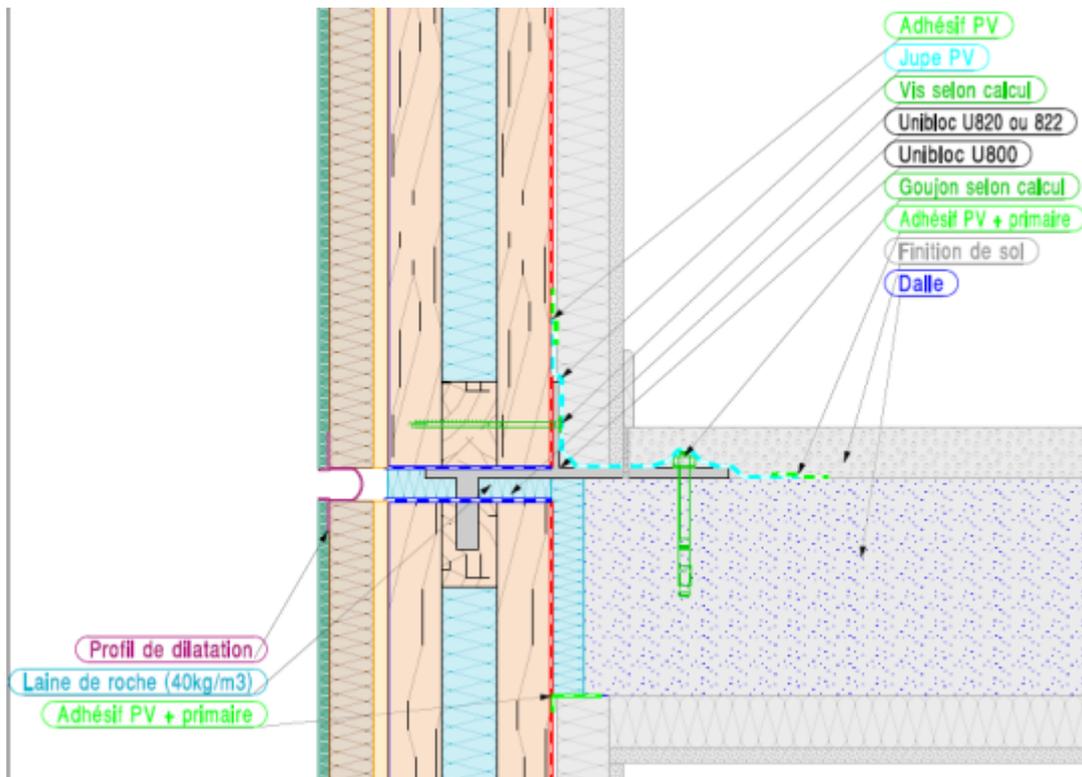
Raccord de panneaux sur dalle béton avec parement extérieur de type enduit sur isolant / coupe verticale
